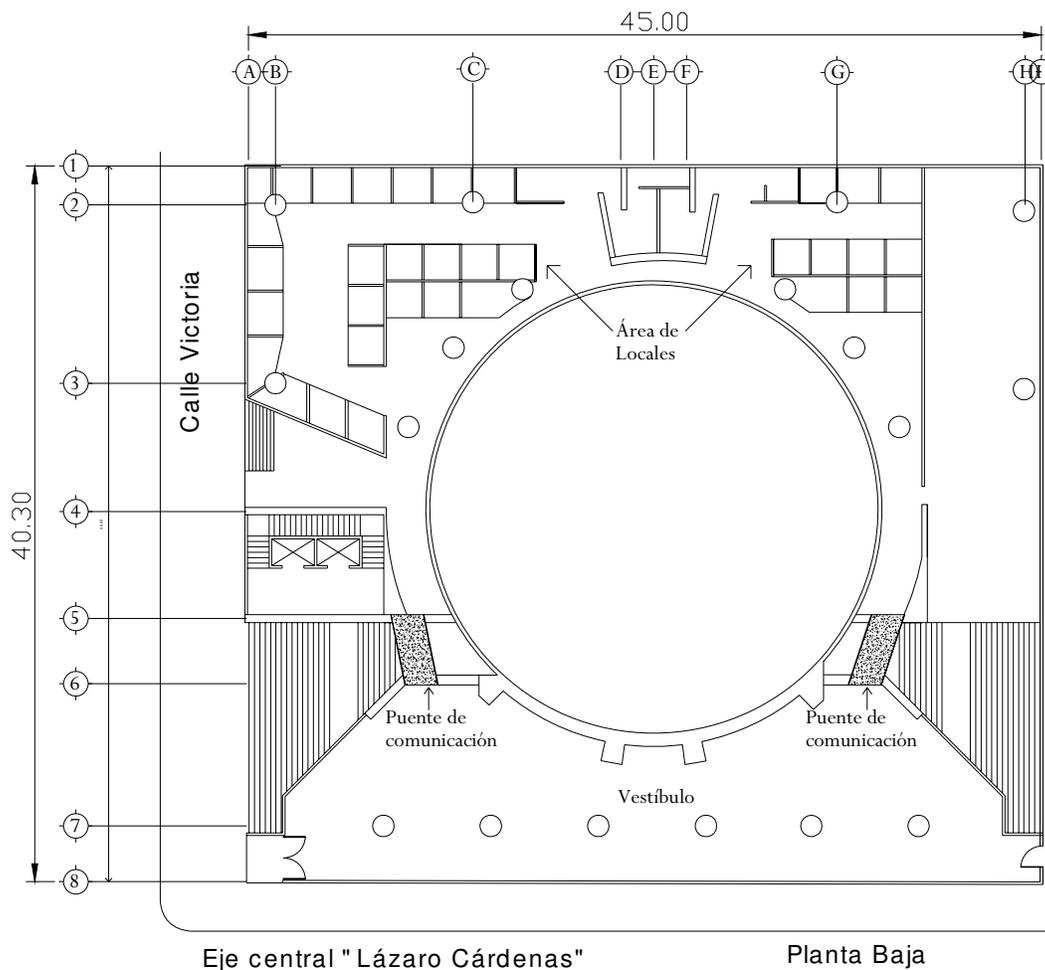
Puentes de comunicación en planta baja, edificio Victoria 7
